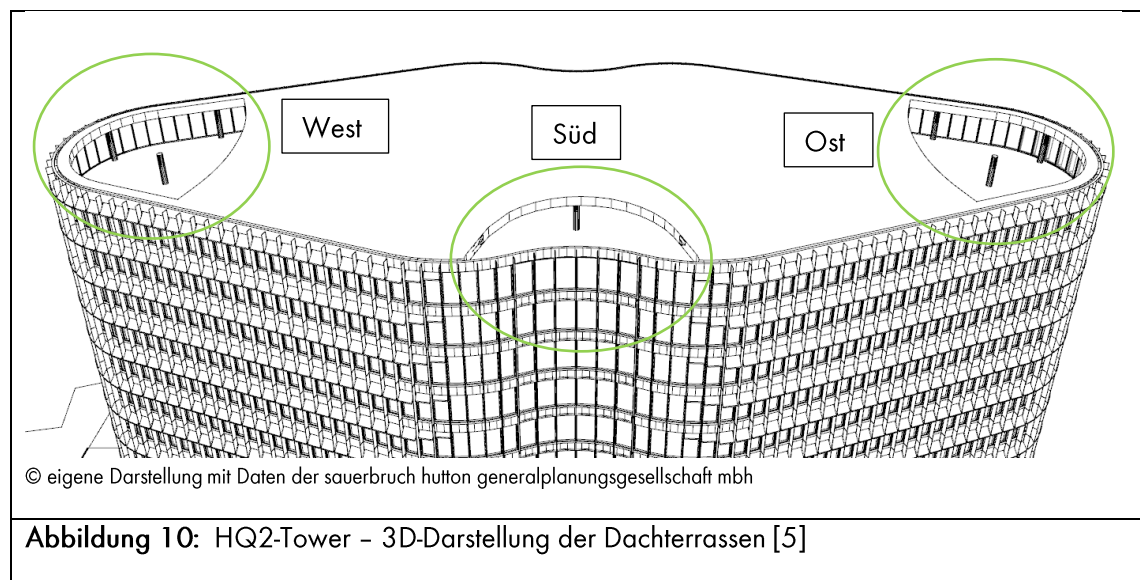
HQ2-Tower – 3D-Darstellung der Dachterrassen [5]
